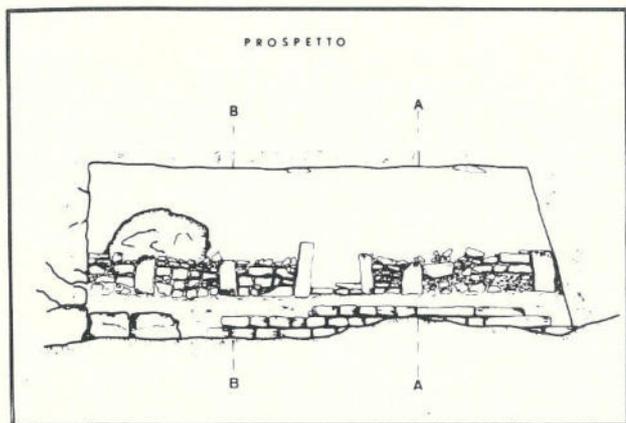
Monte Castellazzo. Scavi 1970. Edificio con muro a telaio. Prospetto.
